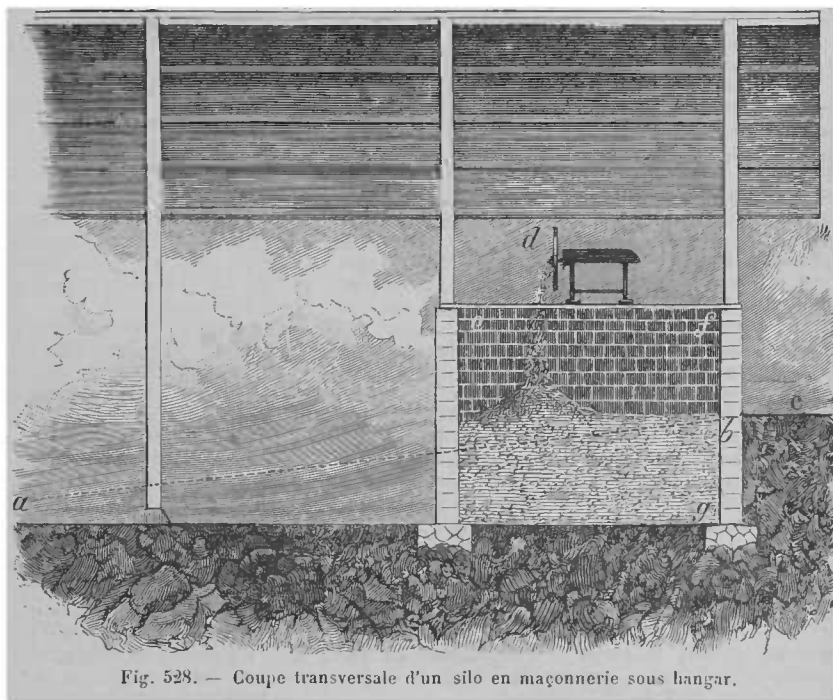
Coupe transversale d'un silo en maçonnerie sous hangar.
